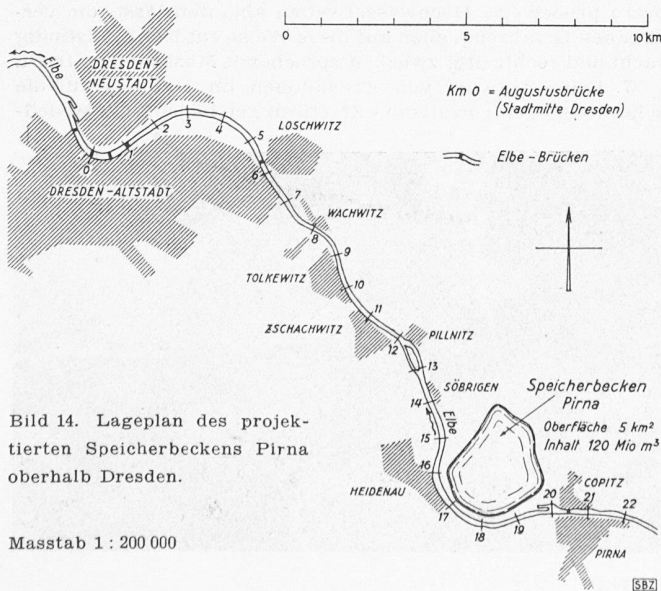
Lageplan des projektierten Speicherbeckens Pirna oberhalb Dresden.
